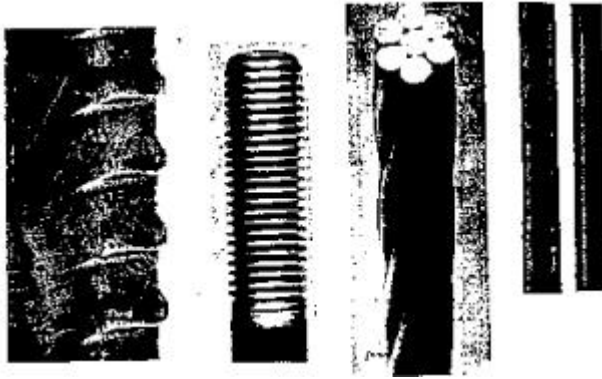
Tipos de Fios, Barras e Cabos para Protensão
